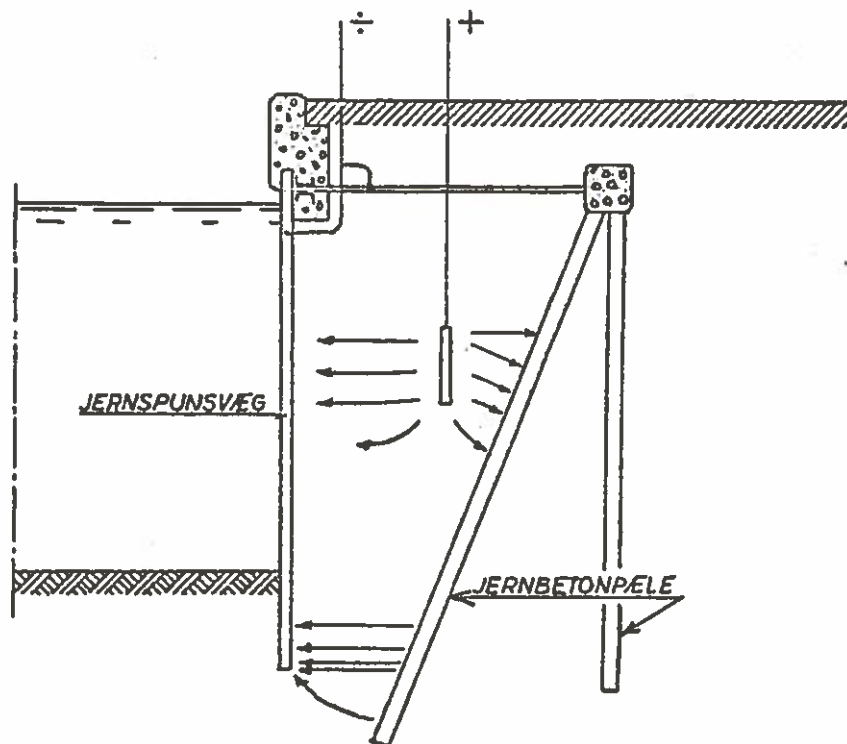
Vagabonderende strøm i skråpæl af armeret beton.
